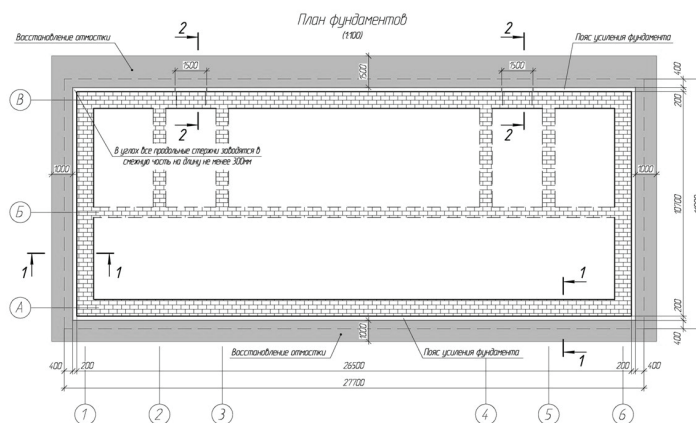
Схема расположения элементов усиления фундаментов под наружными стенами здания. Поперечные внутренние несущие стены специалистами подрядчика не были обнаружены
